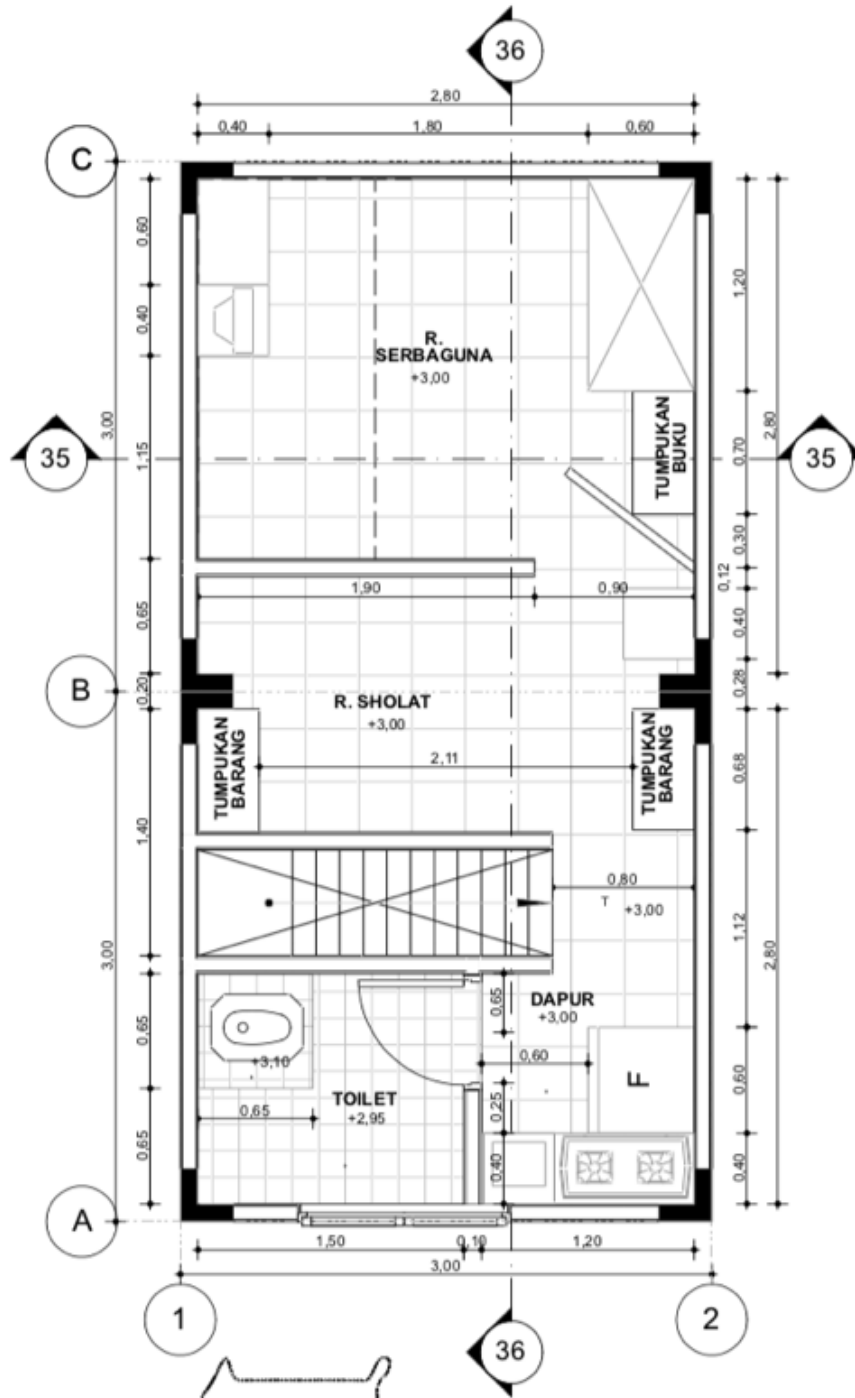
Layout* Denah Lantai Dua Tipe 36
